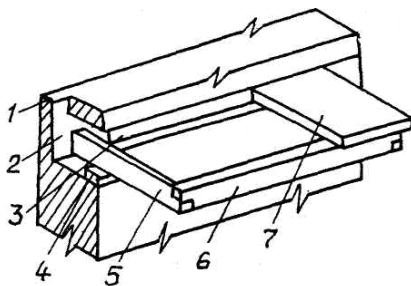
Збірний залізобетонний балкон харківської конструкції:
